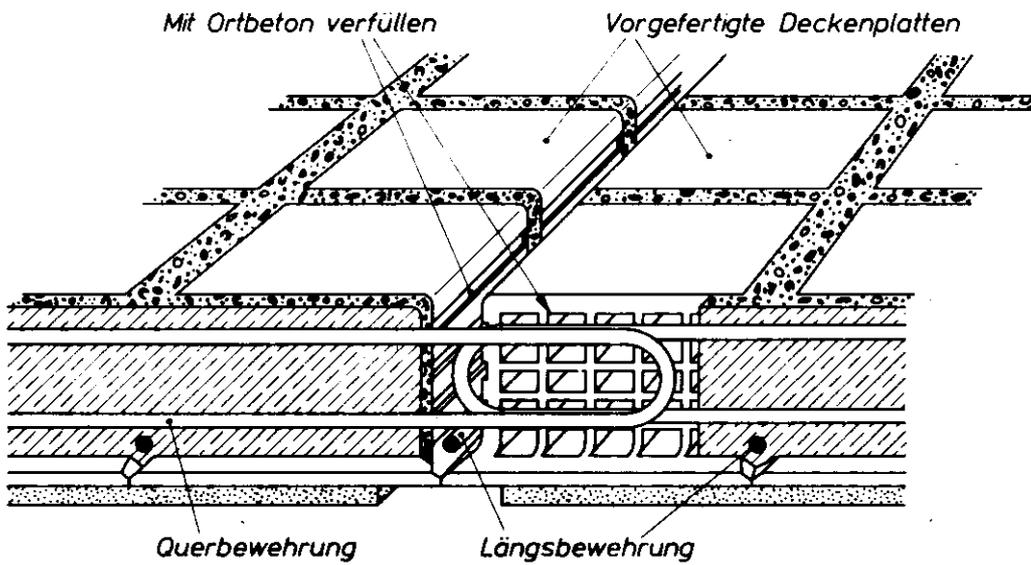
Verbindung zweier Deckenplatten aus Ziegeln mit vollvermörtelbaren Stoßfugen nach DIN 4159; Stoß mit lastverteilender Querrippe
